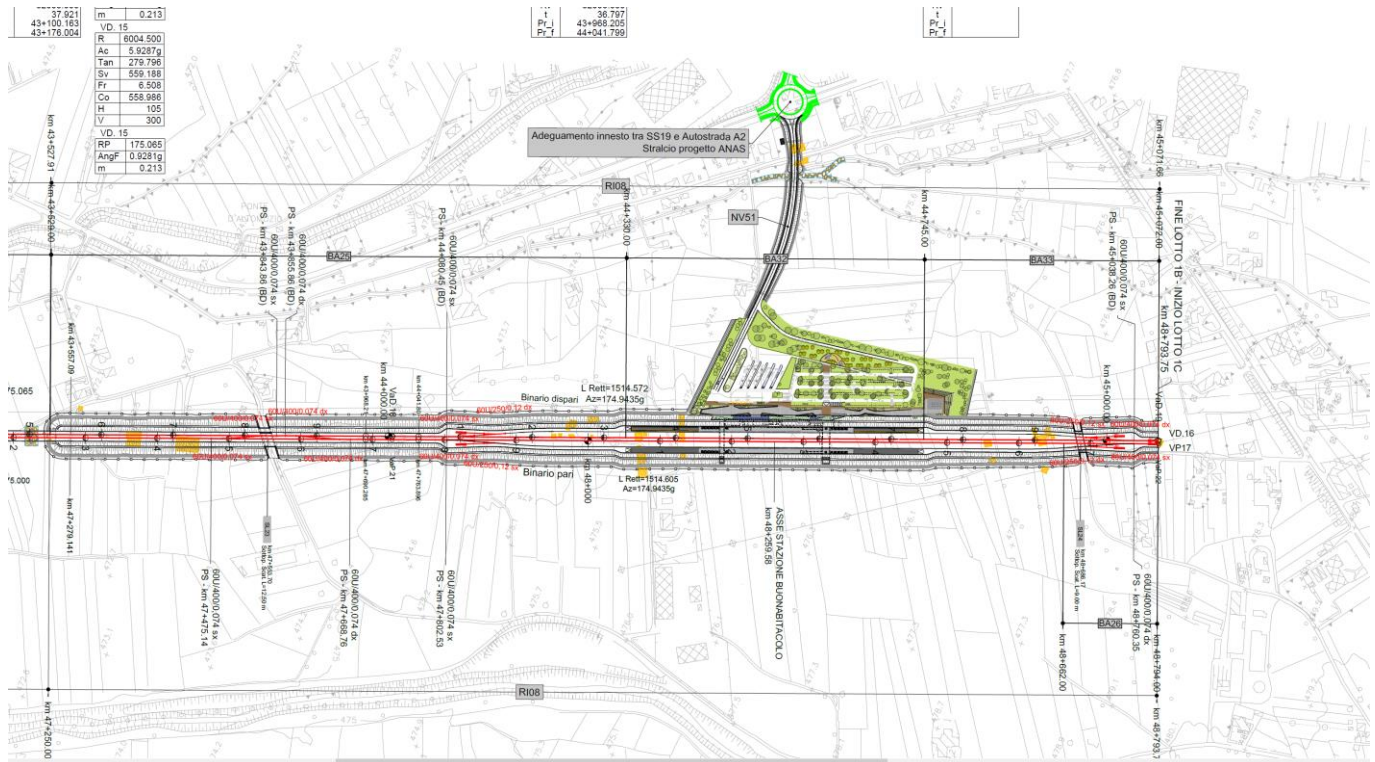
Planimetria di progetto stazione di Buonabitacolo
